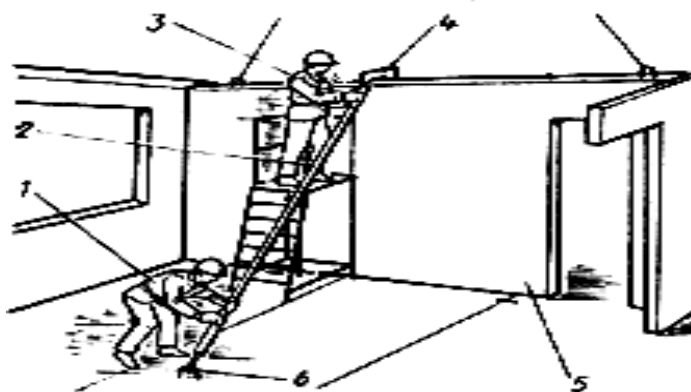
Схема временного закрепления панели: 1 – монтажник 2 разряда; 2 – подкос; 3 – монтажник 4 разряда; 4 – струбцина; 5 – монтируемый элемент; 6 – монтажная петля
